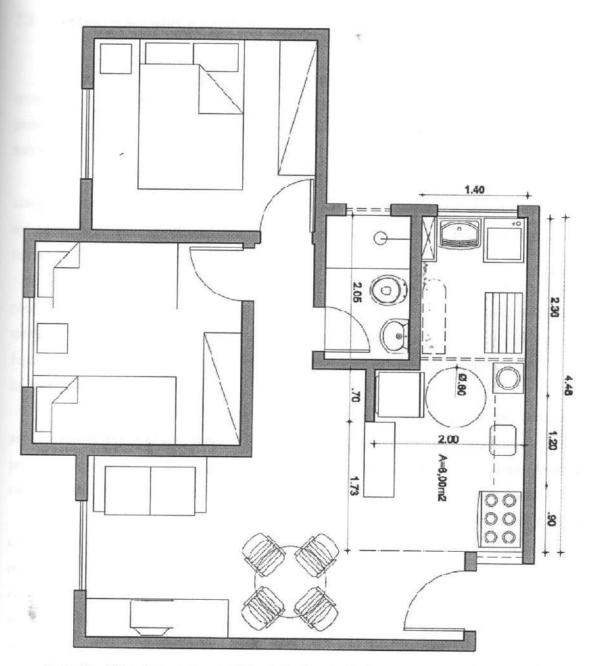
UH do Empreendimento C <u>depois</u> da aplicação das diretrizes propostas. (Fonte: autor)
